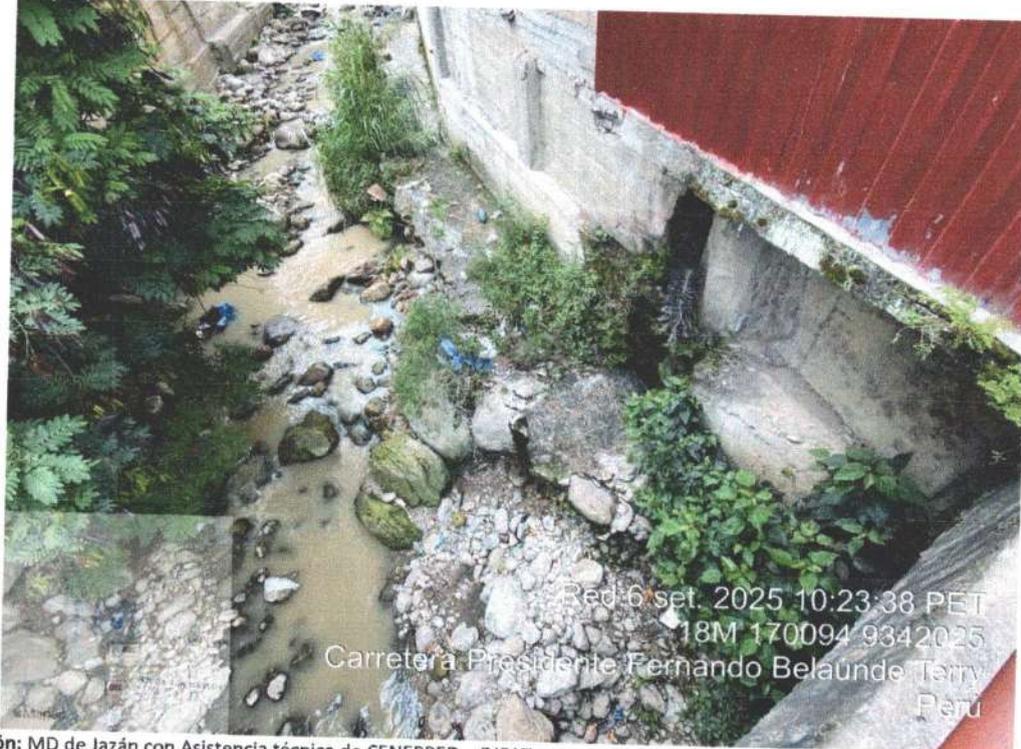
Viviendas construidas sobre el cauce de la quebrada Shiquite.
